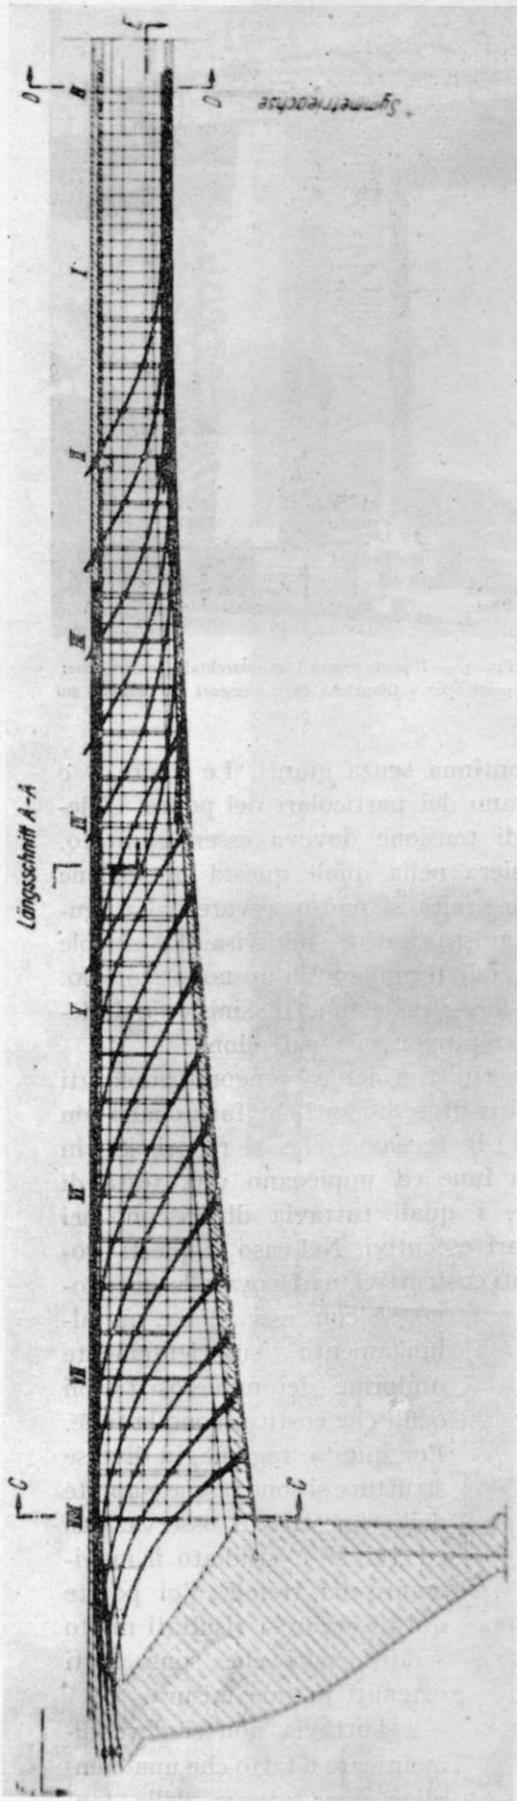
Ponte Hinkel'doy - a Berlino - Disposizione degli elementi di trazione.
